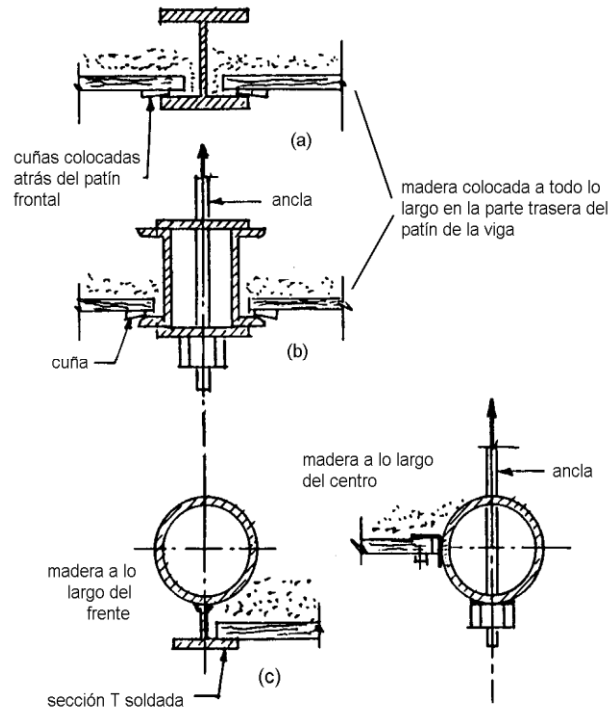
DIVERSOS TIPOS DE PILOTES PARA MURO BERLÍN (A) CON VIGA I O H; (B) SECCIÓN EN CANAL; (C) CON TUBO DE ACERO, XANTHAKOS (1994)
